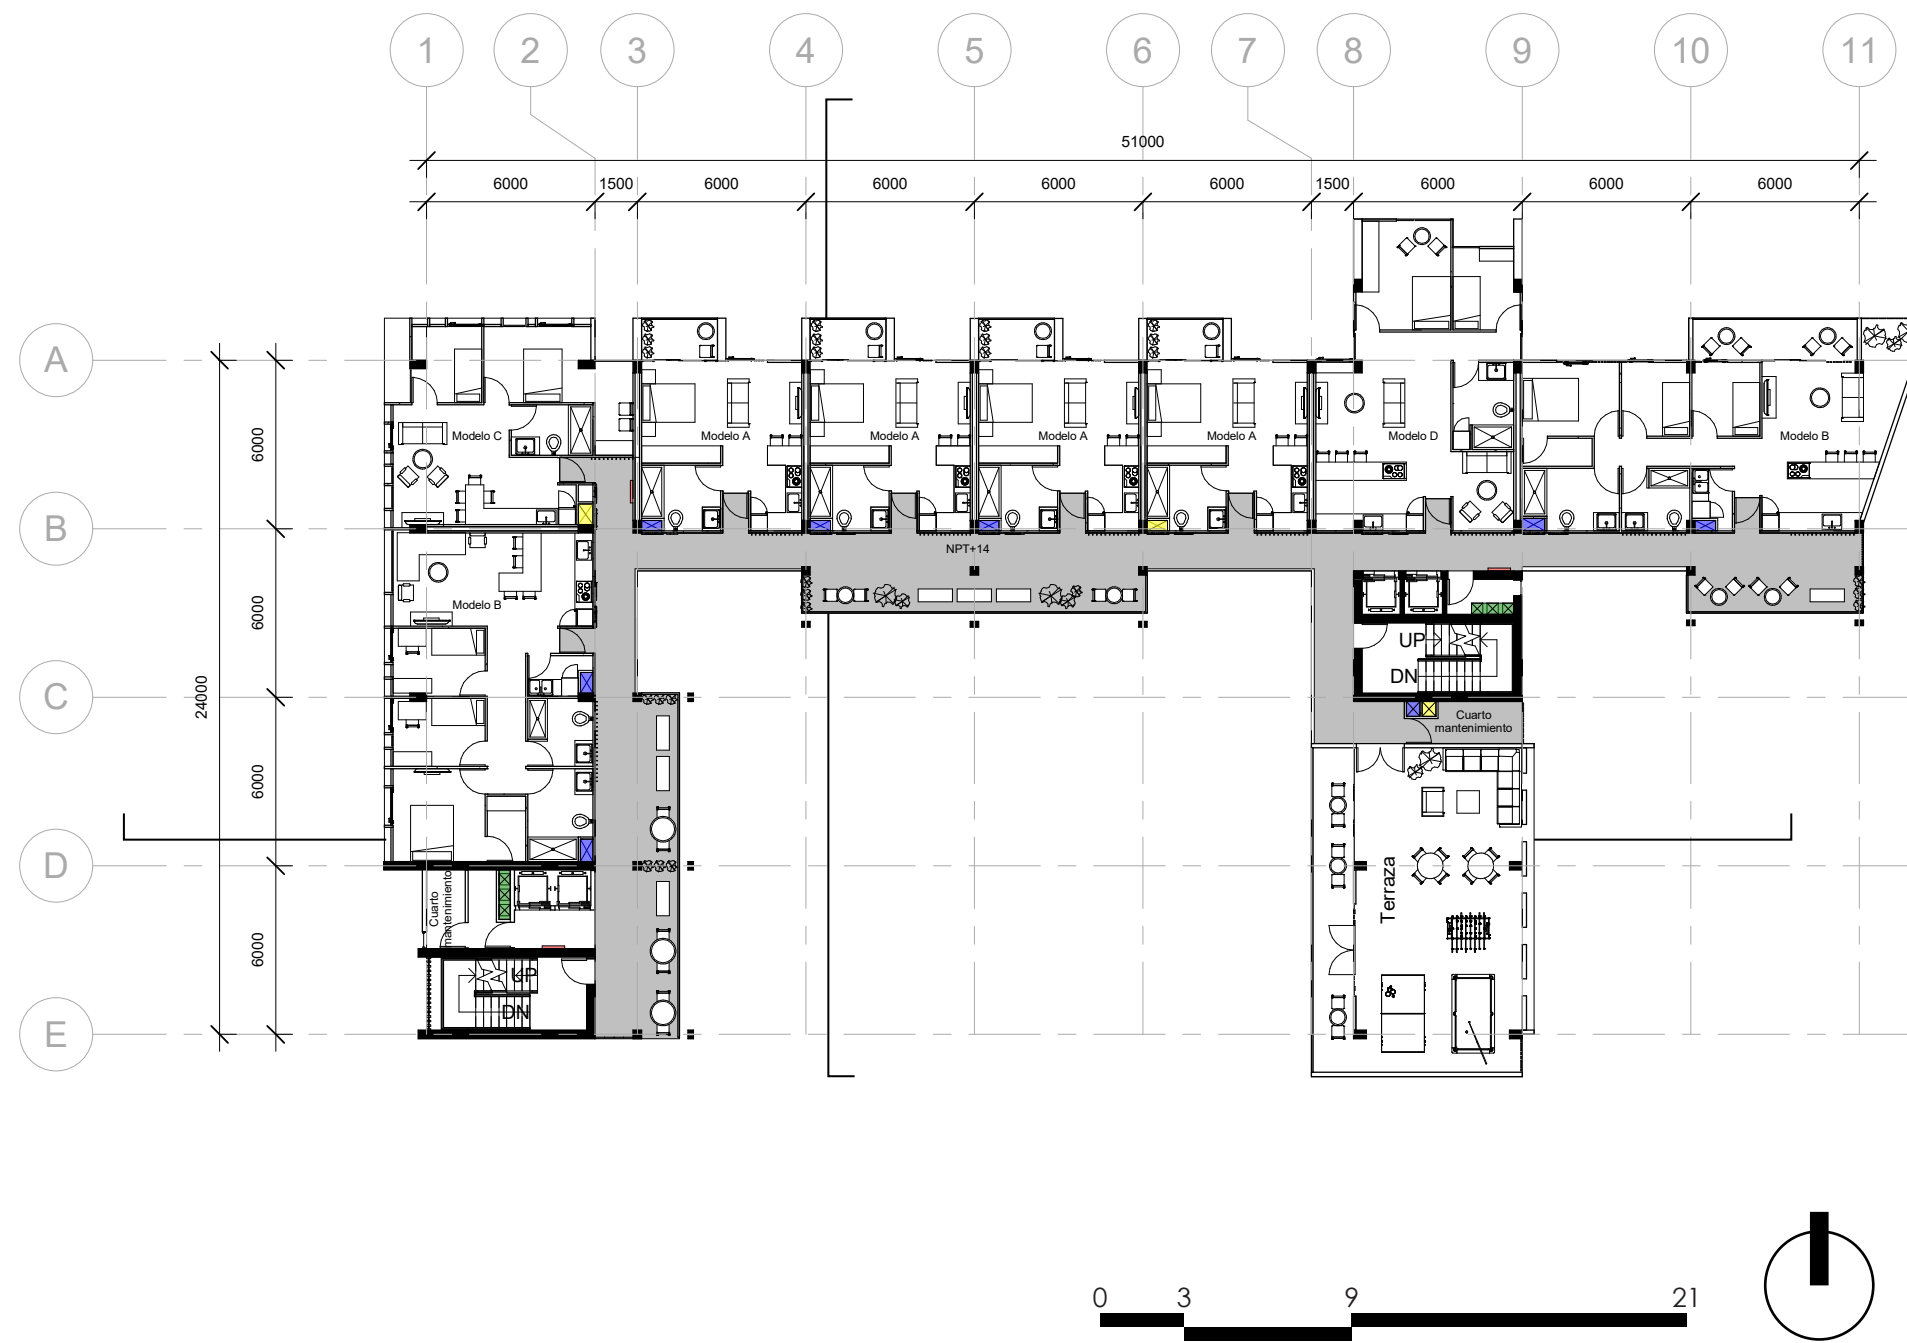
Planta nivel 4. Fuente: Elaboración propia.
